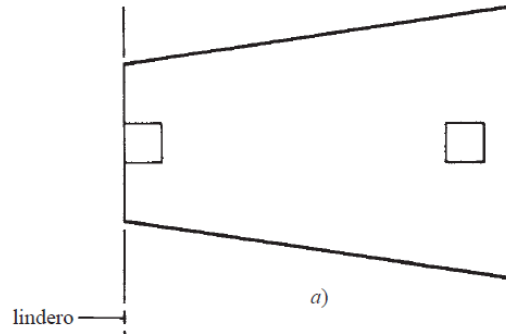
Zapata trapezoidal combinada (McCormac & Brown, 2016).
